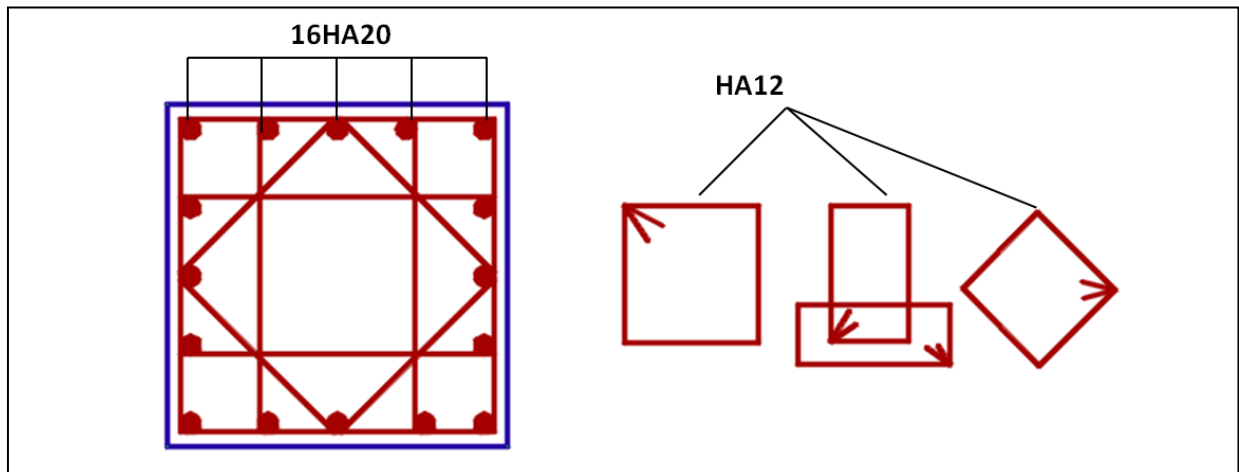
Schéma de ferrailage du poteau 60x60
